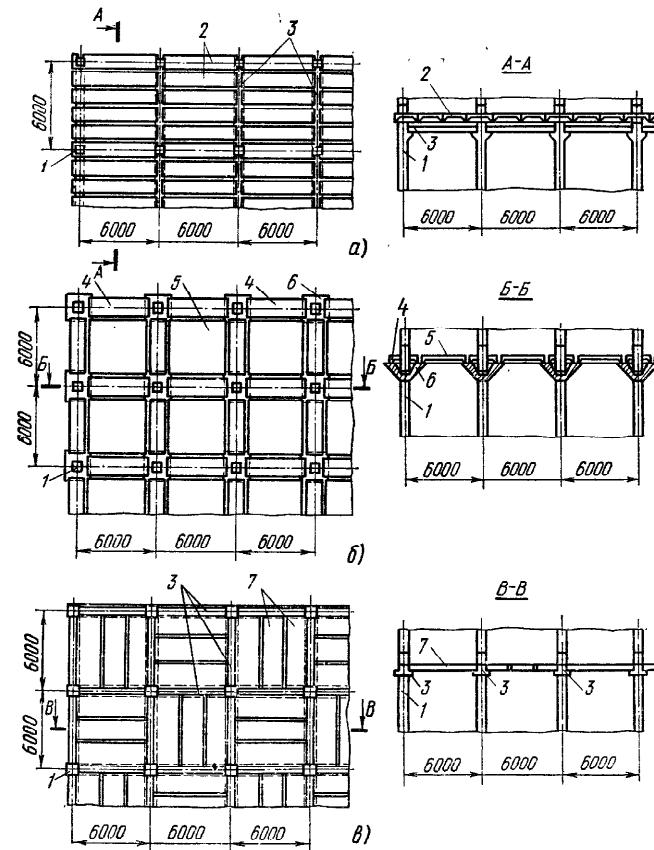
Междуэтажные перекрытия многоэтажных зданий:
